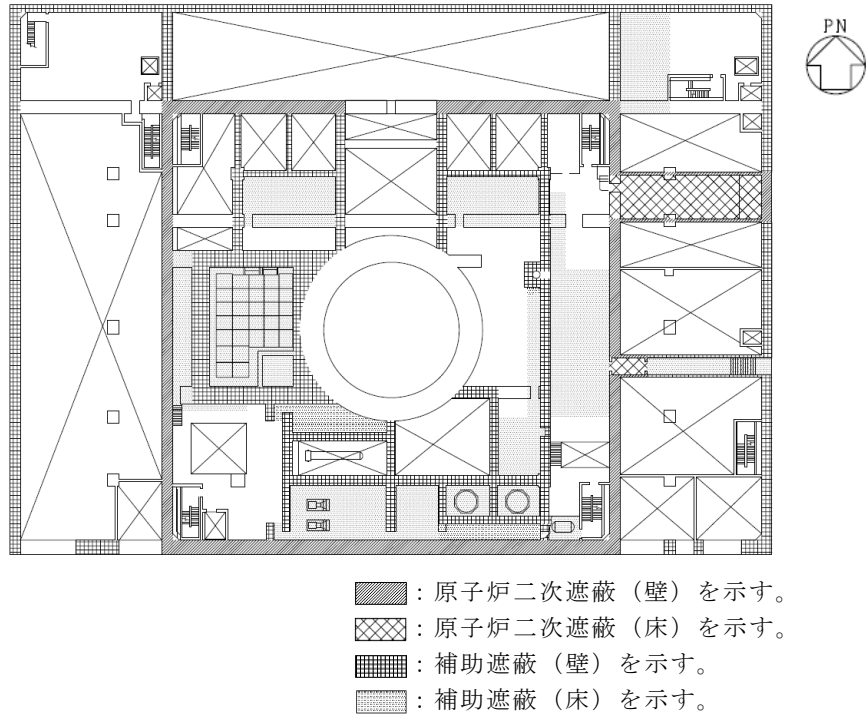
(7) 原子炉二次遮蔽及び補助遮蔽（原子炉建物）の範囲の平面図
